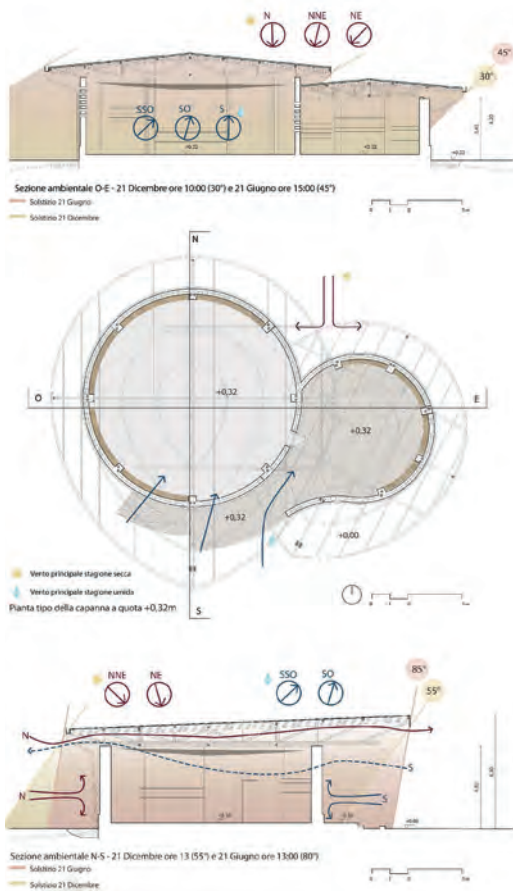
| Sezioni bioclimatiche e pianta della capanna tipo
